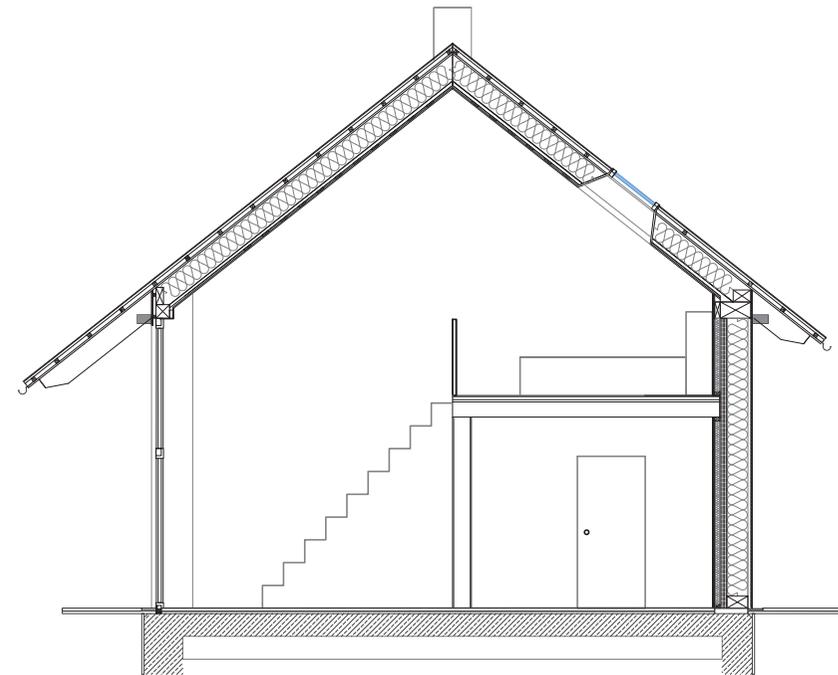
Schnitt Atelier - Dachkammer Eltern
